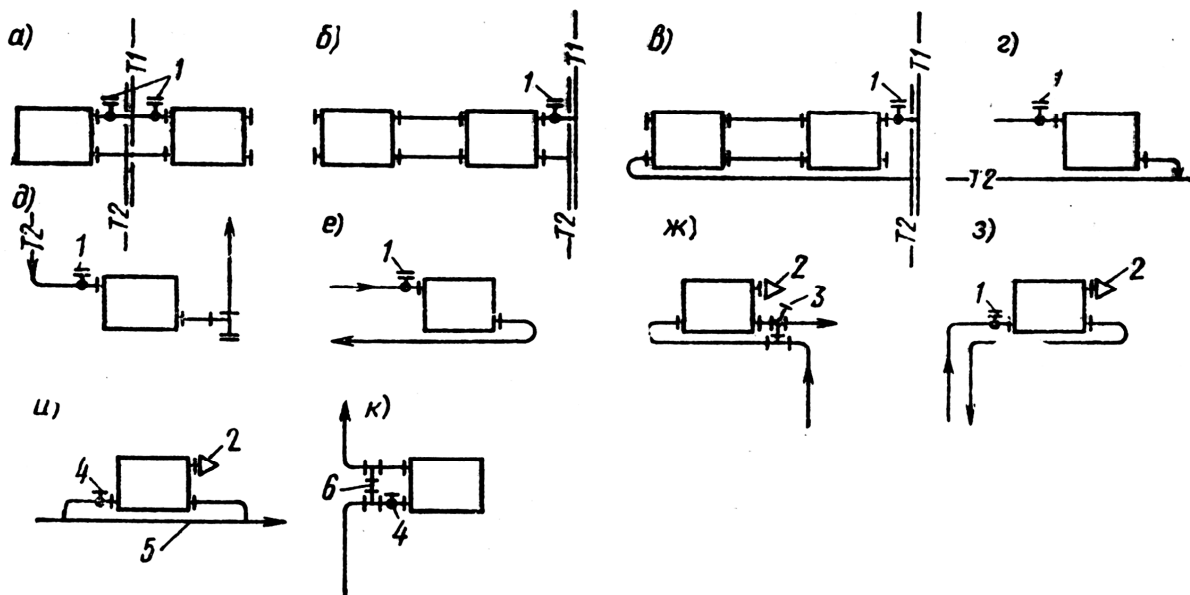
Присоединение отопительных приборов к теплопроводам систем отопления
